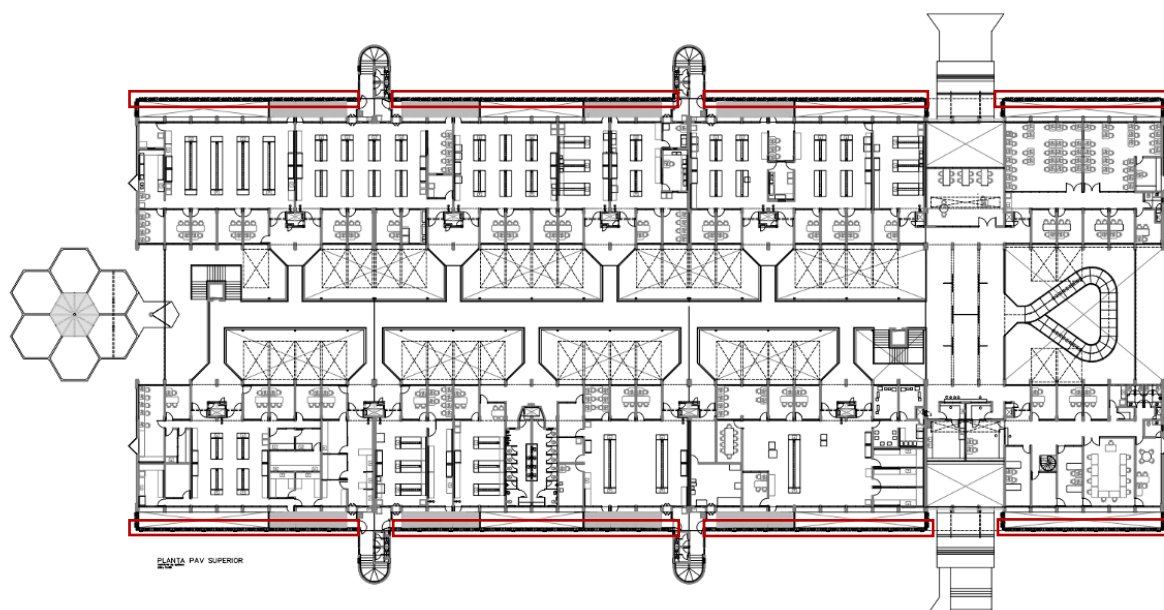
Instituto de Química da Universidade de Brasília DF: Planta do pavimento superior.
